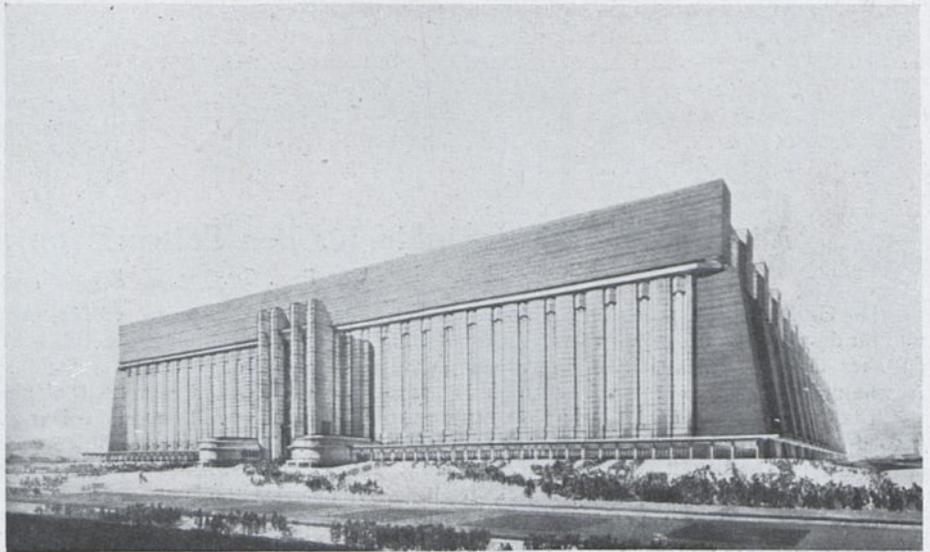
Entwurf Tournon und Chappey für die Pariser Ausstellungshalle.
